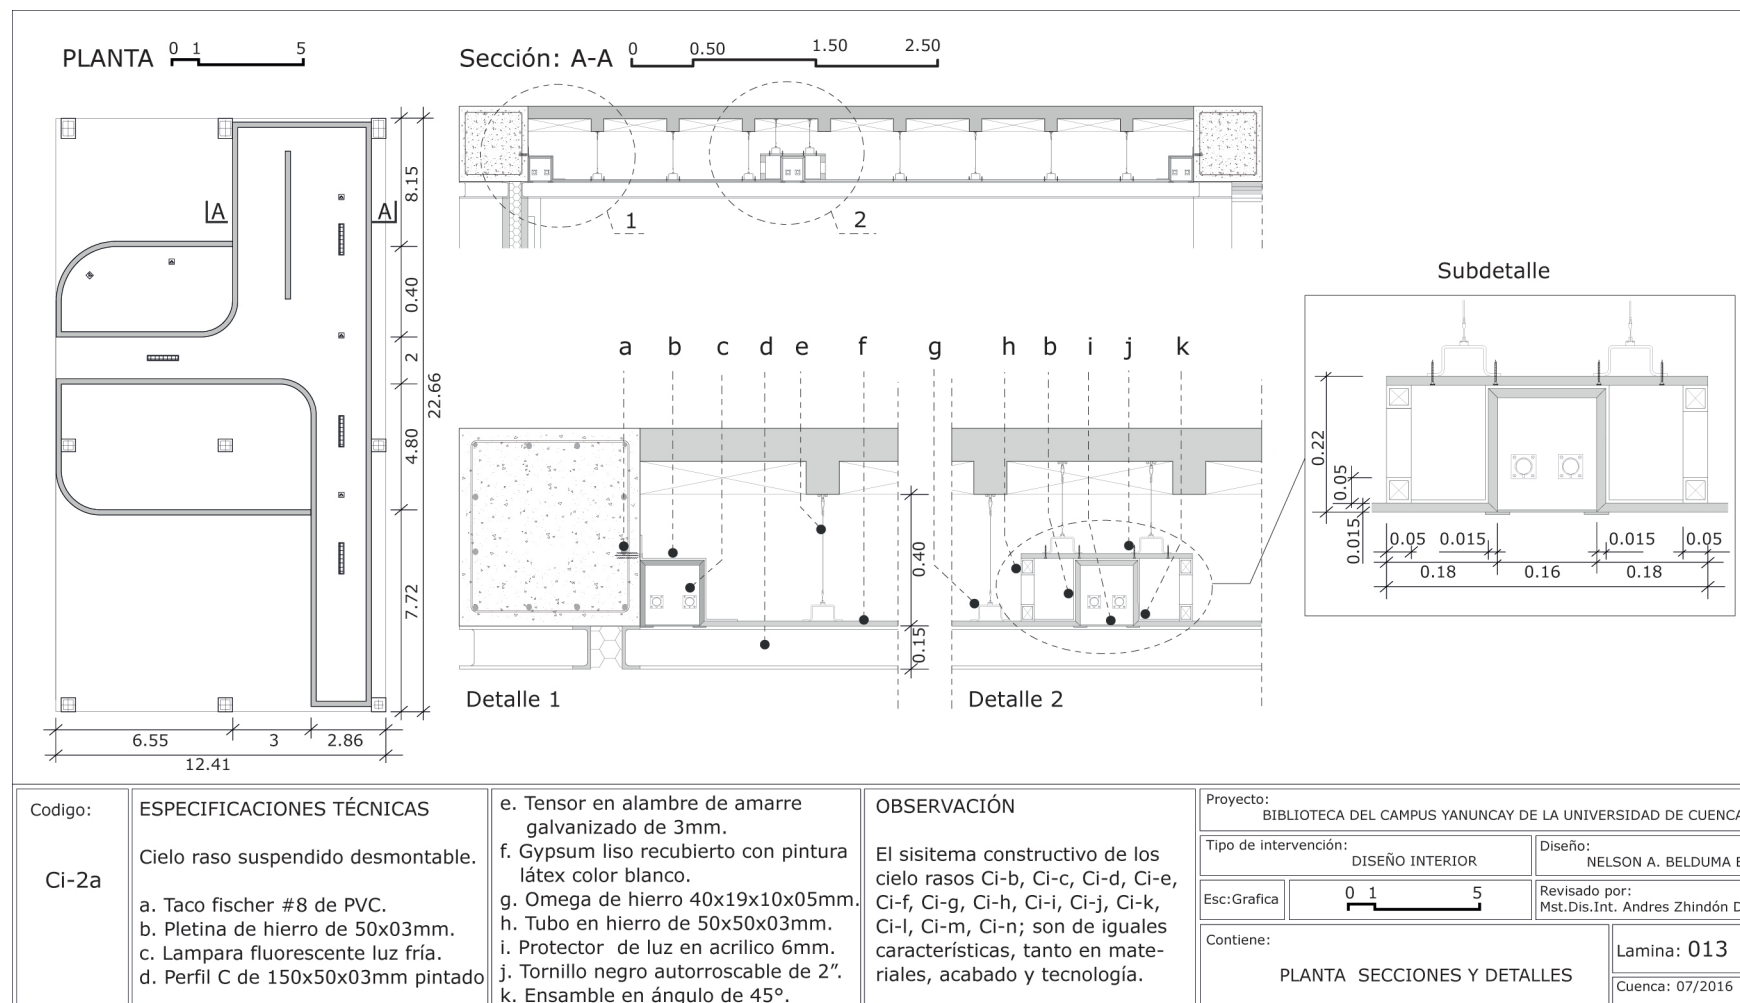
Planta, secciones y detalles. Cielo raso general. Ci-2a.
